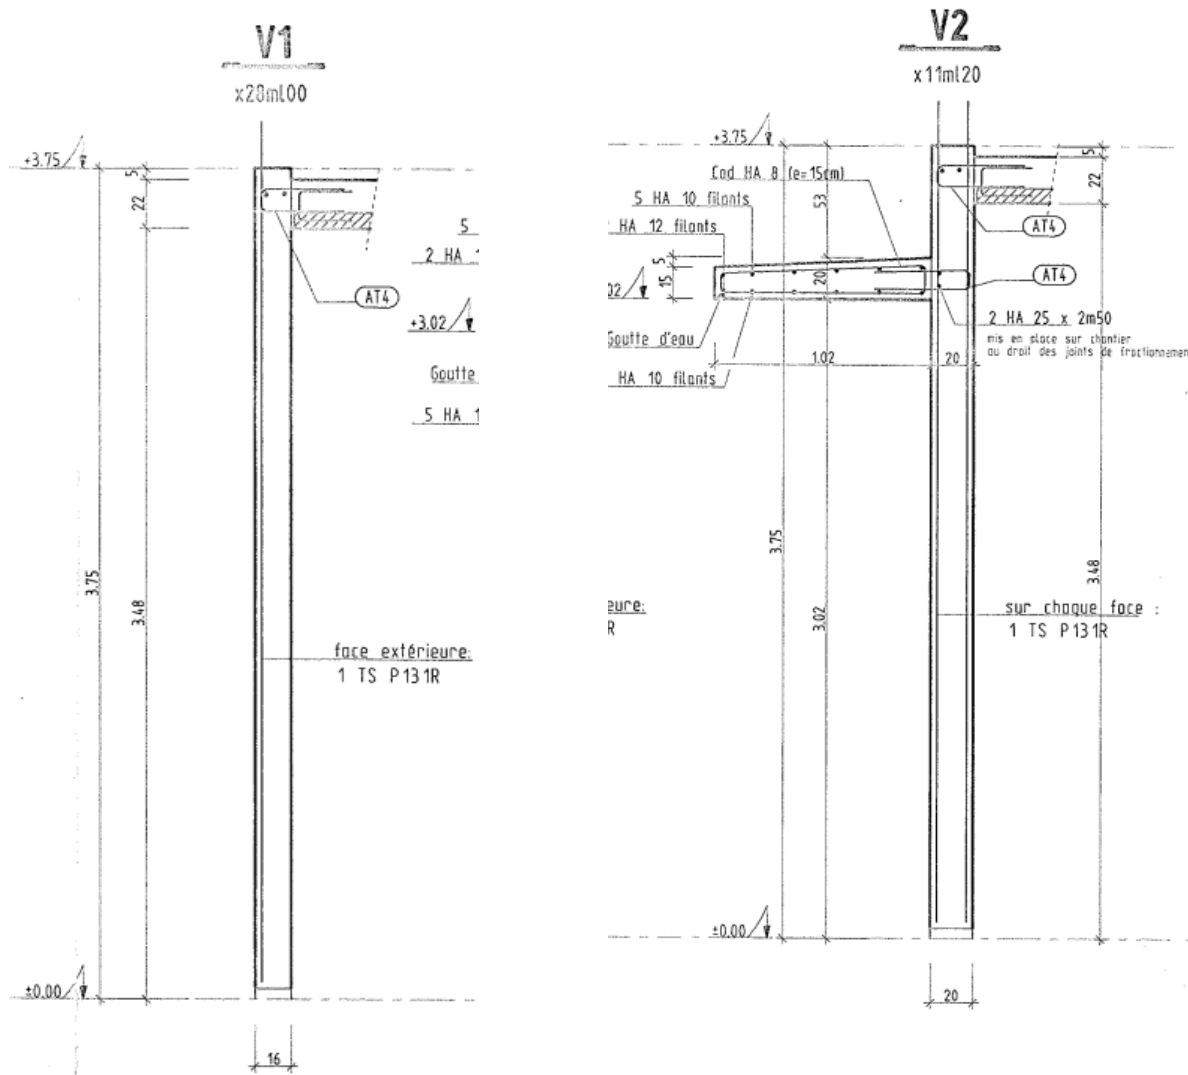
Ferrailage théorique des voiles V1 & V2 / Plan 96.158 – EXE 12A
